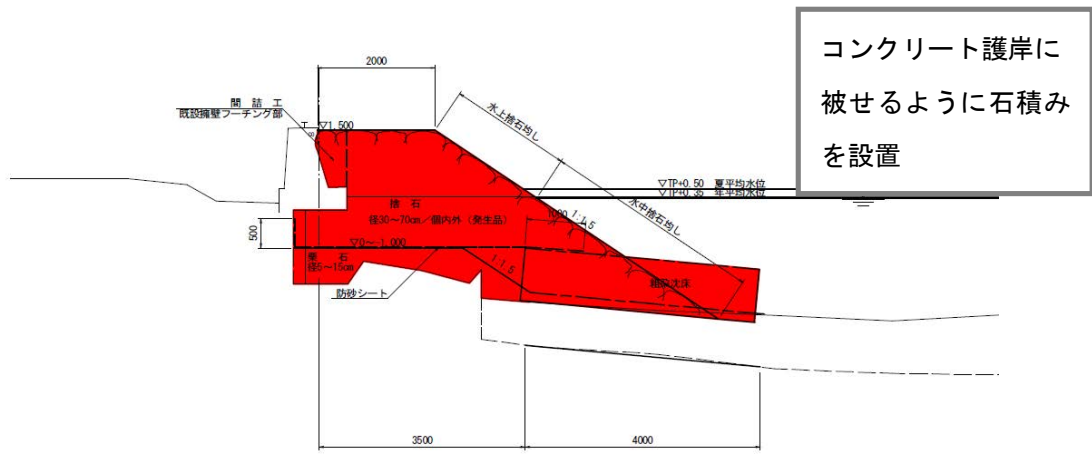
石積み護岸の断面図（三方湖で施工された護岸）
